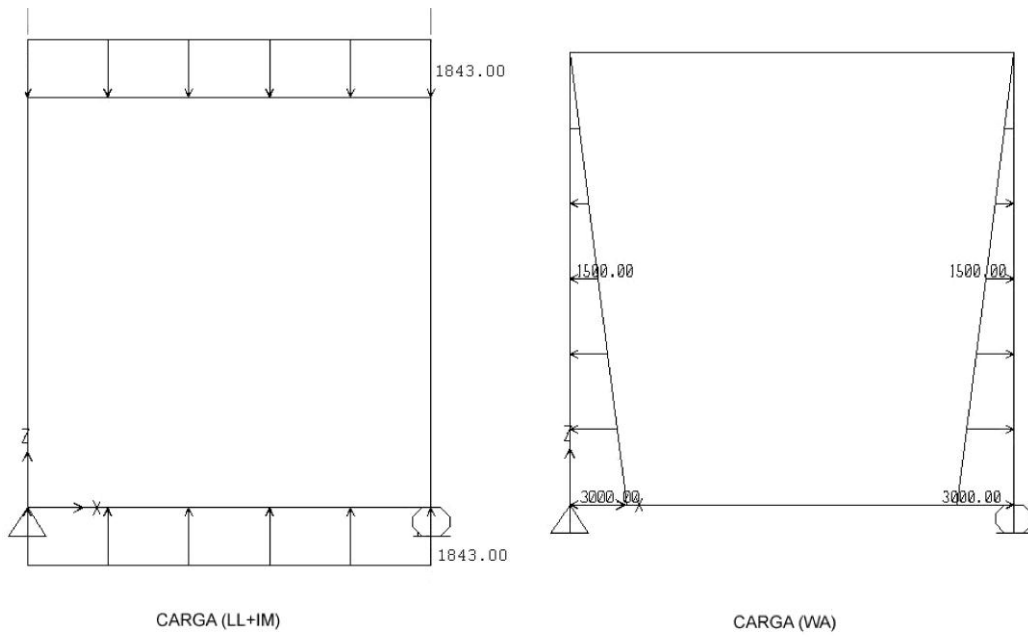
Cargas LL+IM y WA aplicadas en la alcantarilla
